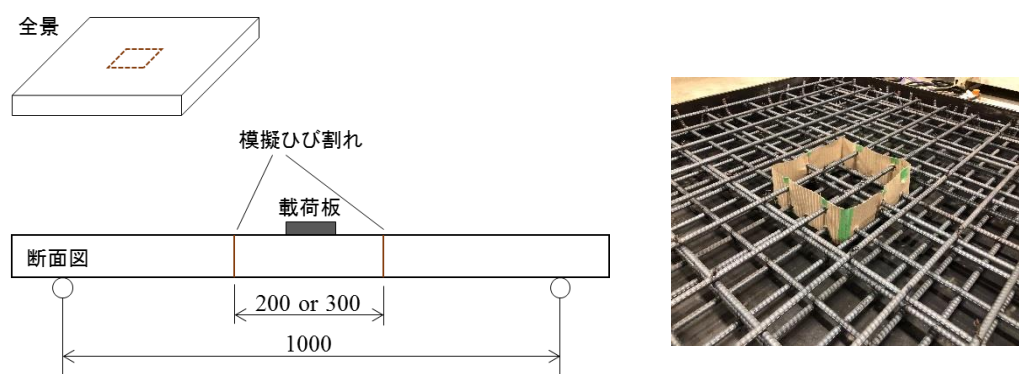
鉛直模擬ひび割れの導入方法
